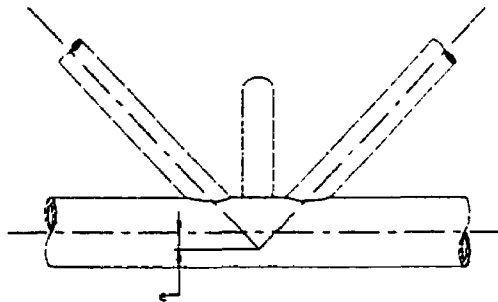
Fissuration d'un longeron sur une structure en service
